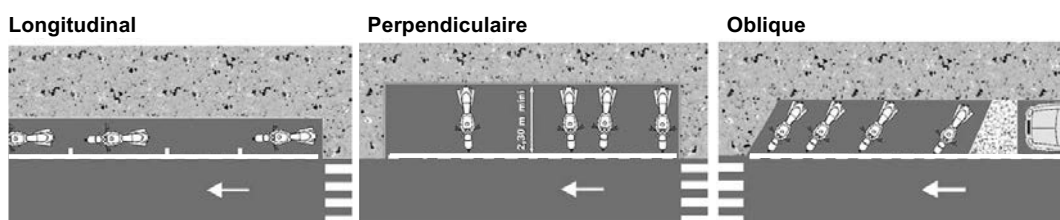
Exemples de disposition du stationnement le long de la chaussée (source : CEREMA).
